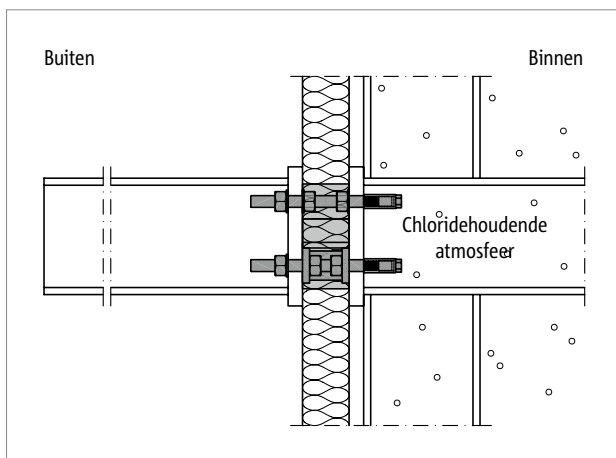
Schöck Isokorb® T type S-N en T type S-V: achteraf gemonteerde, ondersteunde staalconstructie; meer renovatievoorbeelden zie pag. 101
